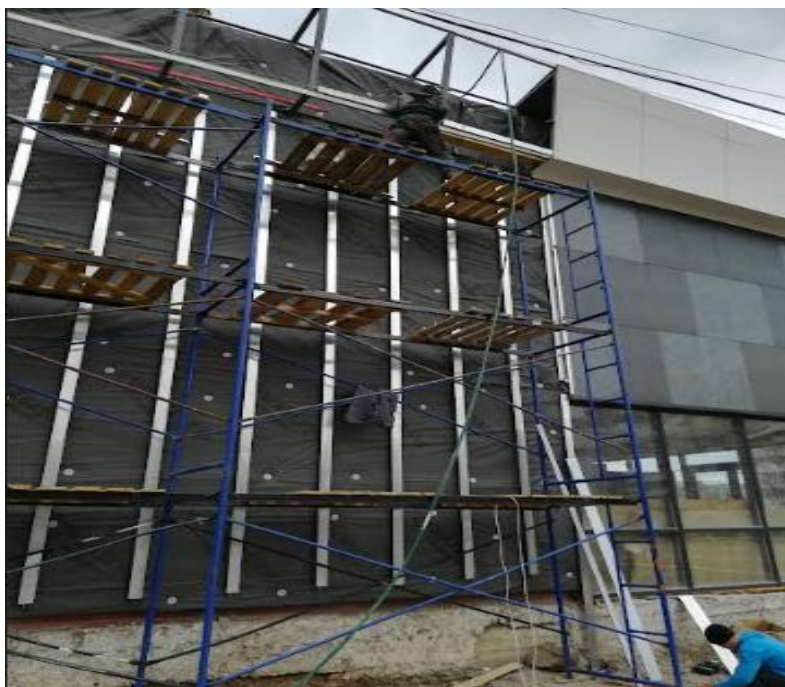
Фрагмент утеплення стіни громадської будівлі методом навісного фасаду (м. Вінниця, громадська будівля).
